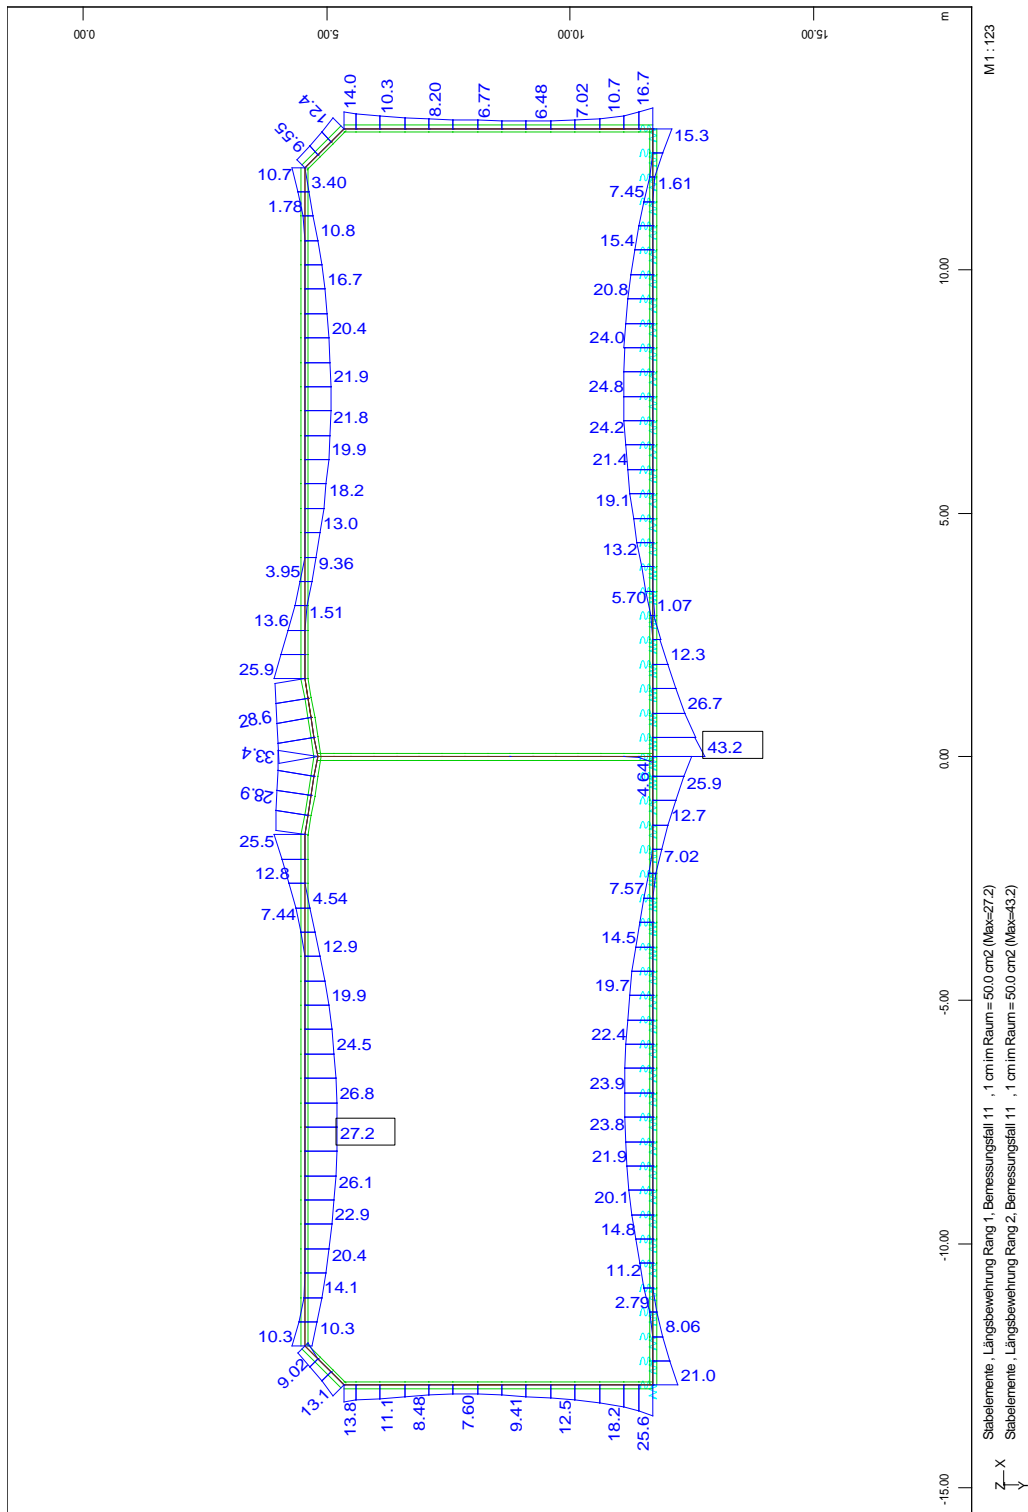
statisch erforderliche Biegebewehrung, außergewöhnliche Bemessungssituation
